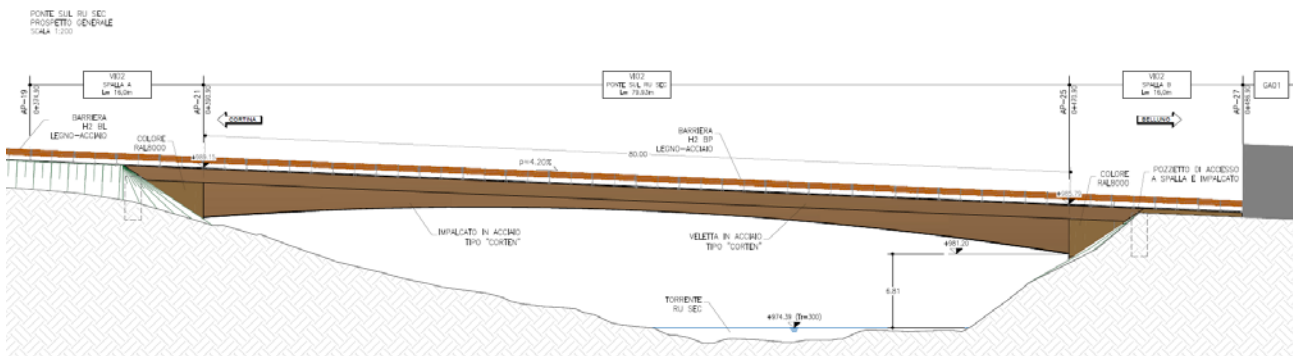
Prospetto Ponte Ru Sec del Progetto Esecutivo
